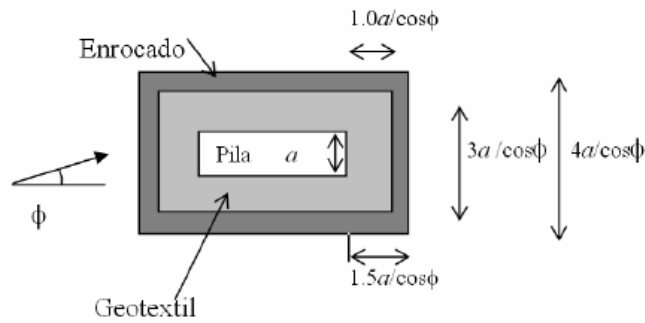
30 Enrocado colocado en excavación previamente hecha.
